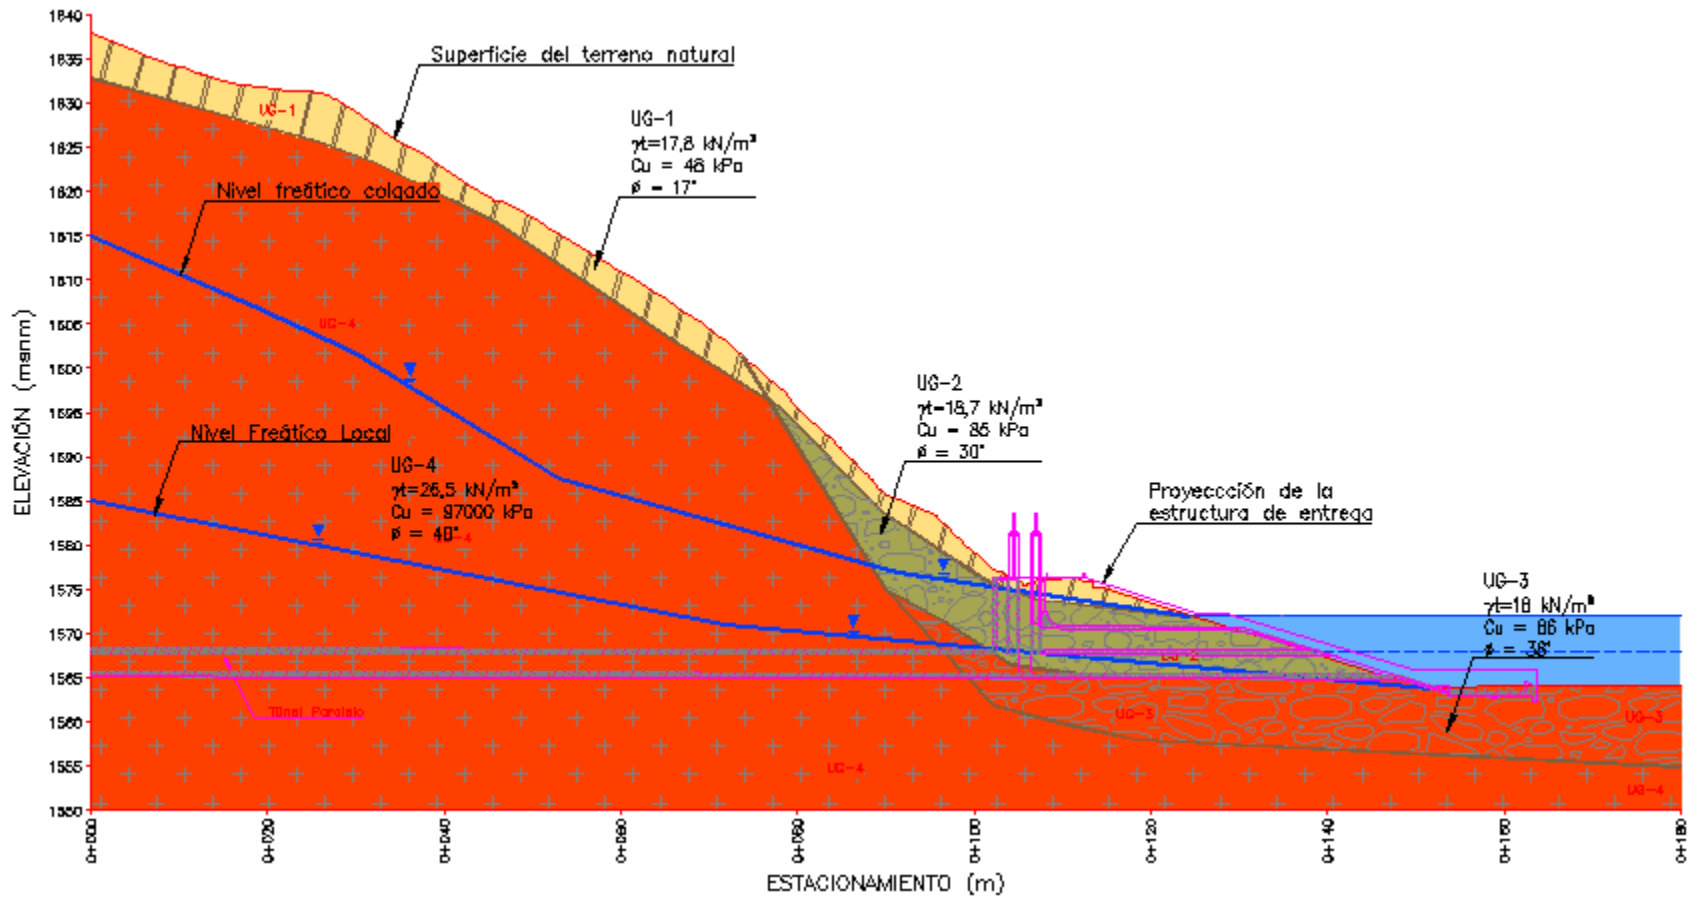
Perfil longitudinal con el modelo geotécnico desarrollado para la Estructura de Entrega al Embalse
